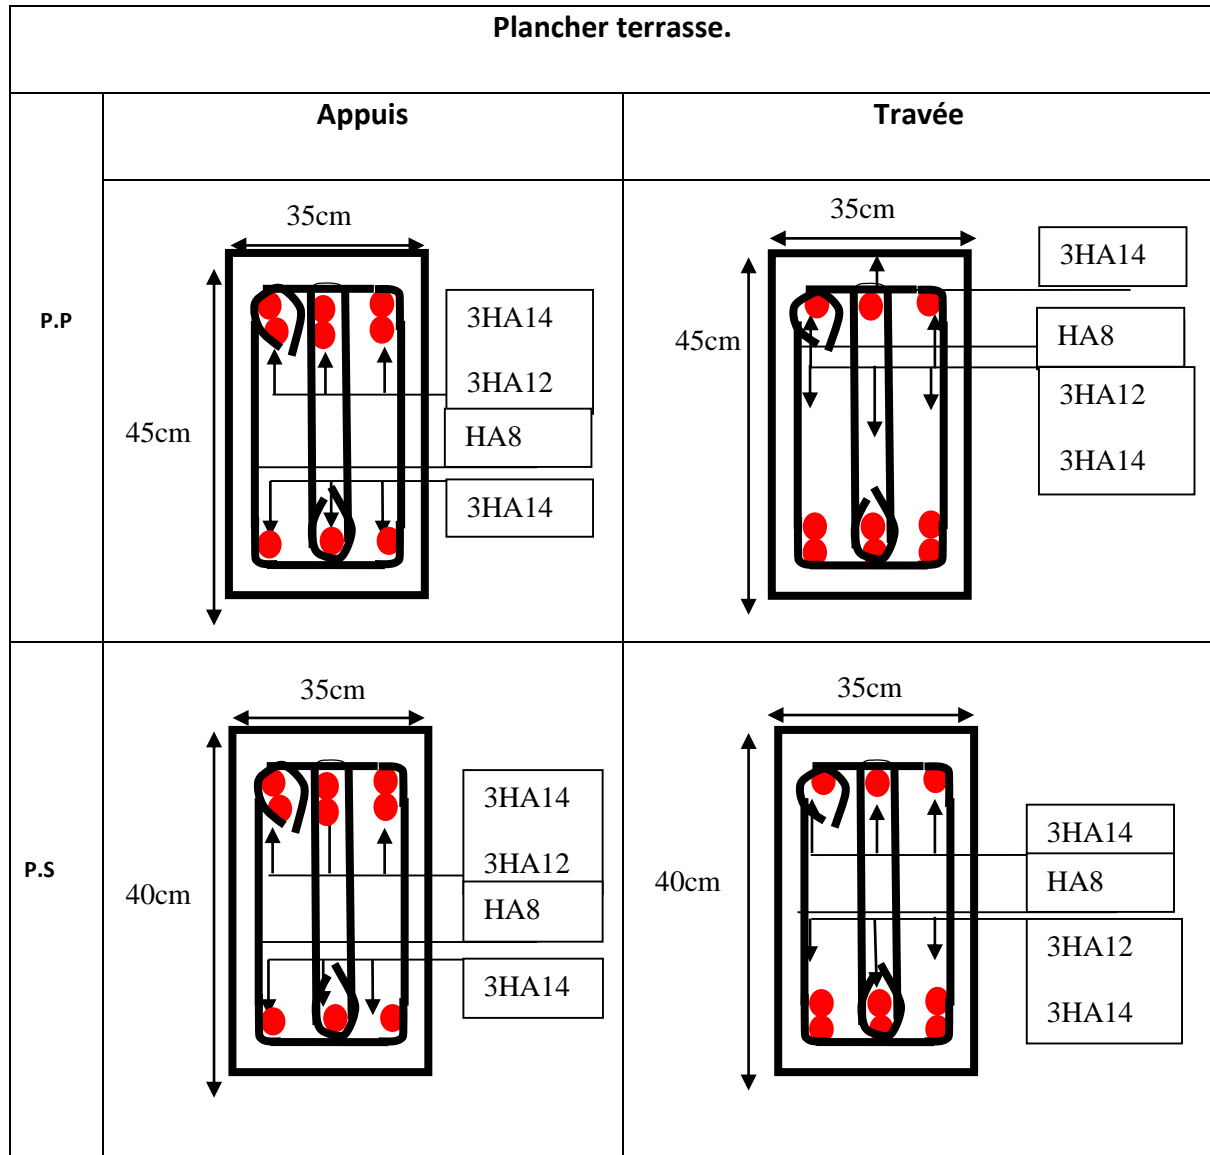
Schéma de ferrailage des poutres principales et secondaires de la terrasse
